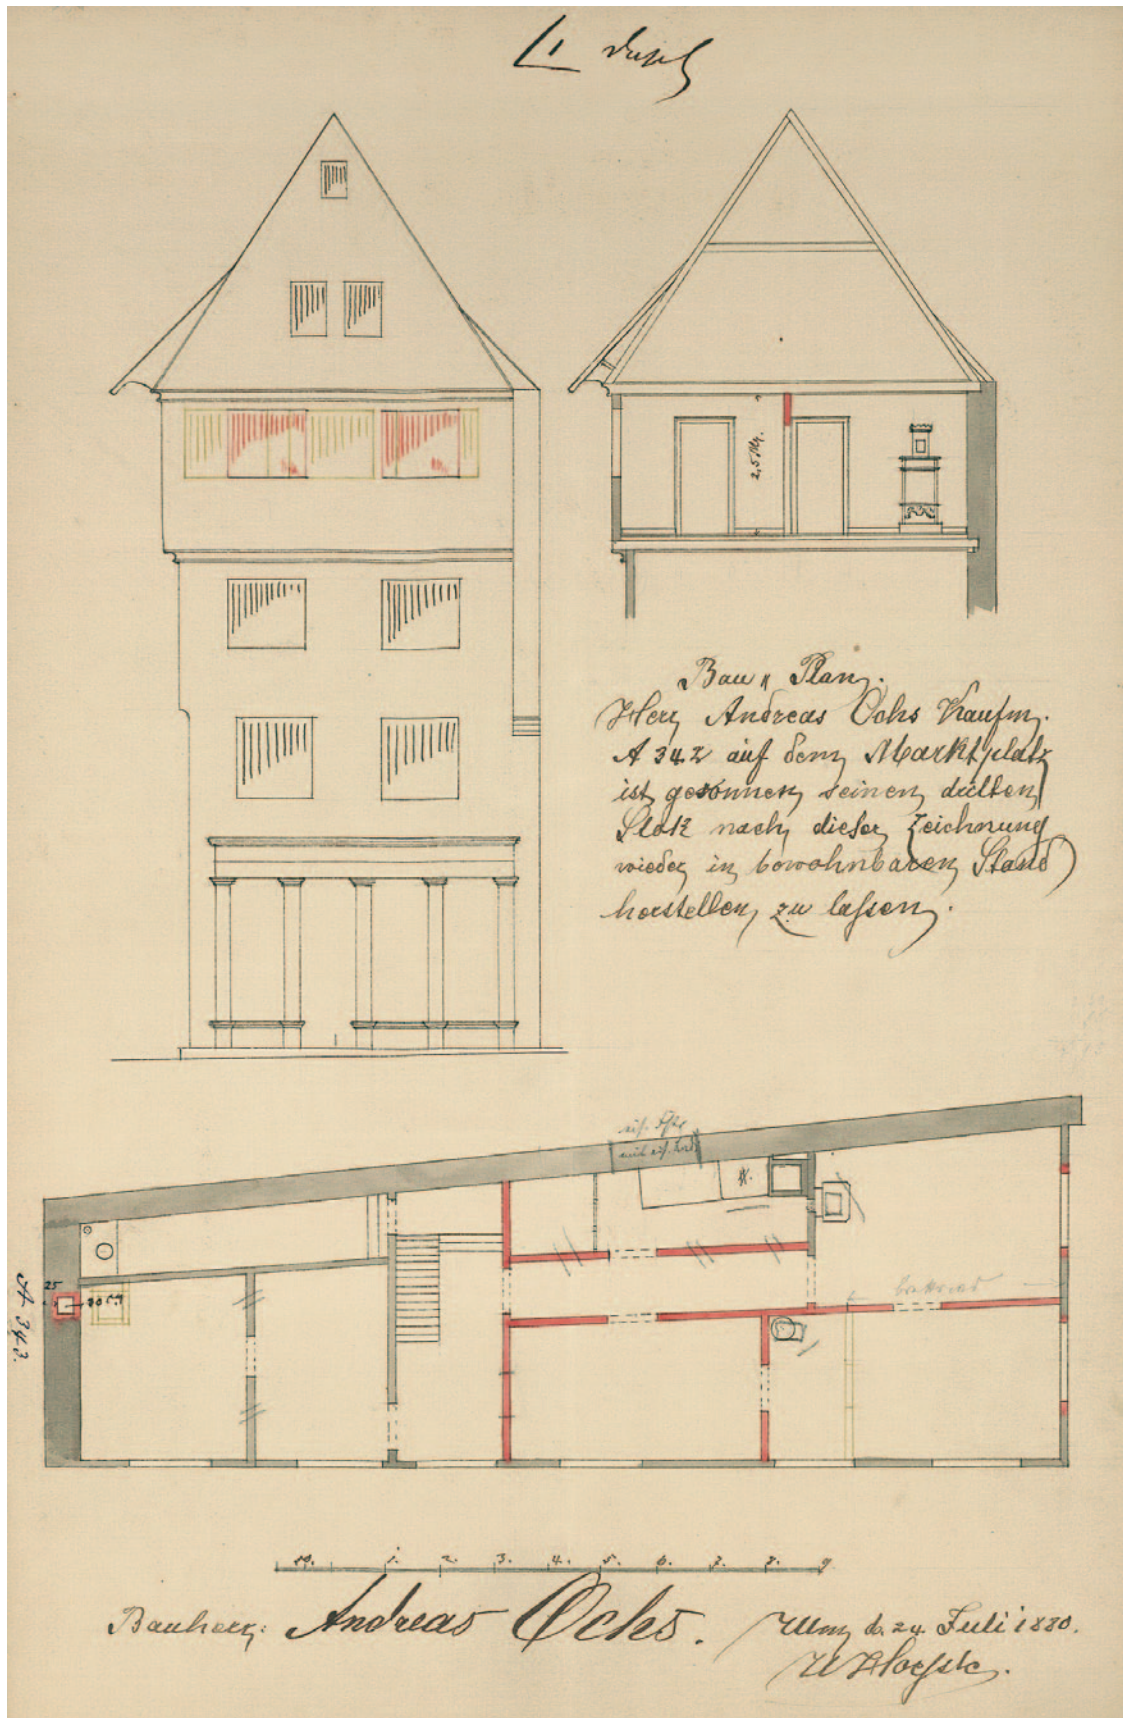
Gebäude Sattlergasse 21 (A 342), Ansicht des Ostgiebels und Grundriss des 3. Stockwerks, Zustand nach Baumaßnahme 1880.
